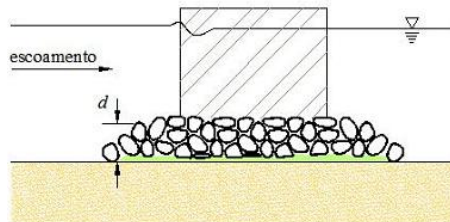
Corte esquemático de tapete de enrocamento sem escavação.
